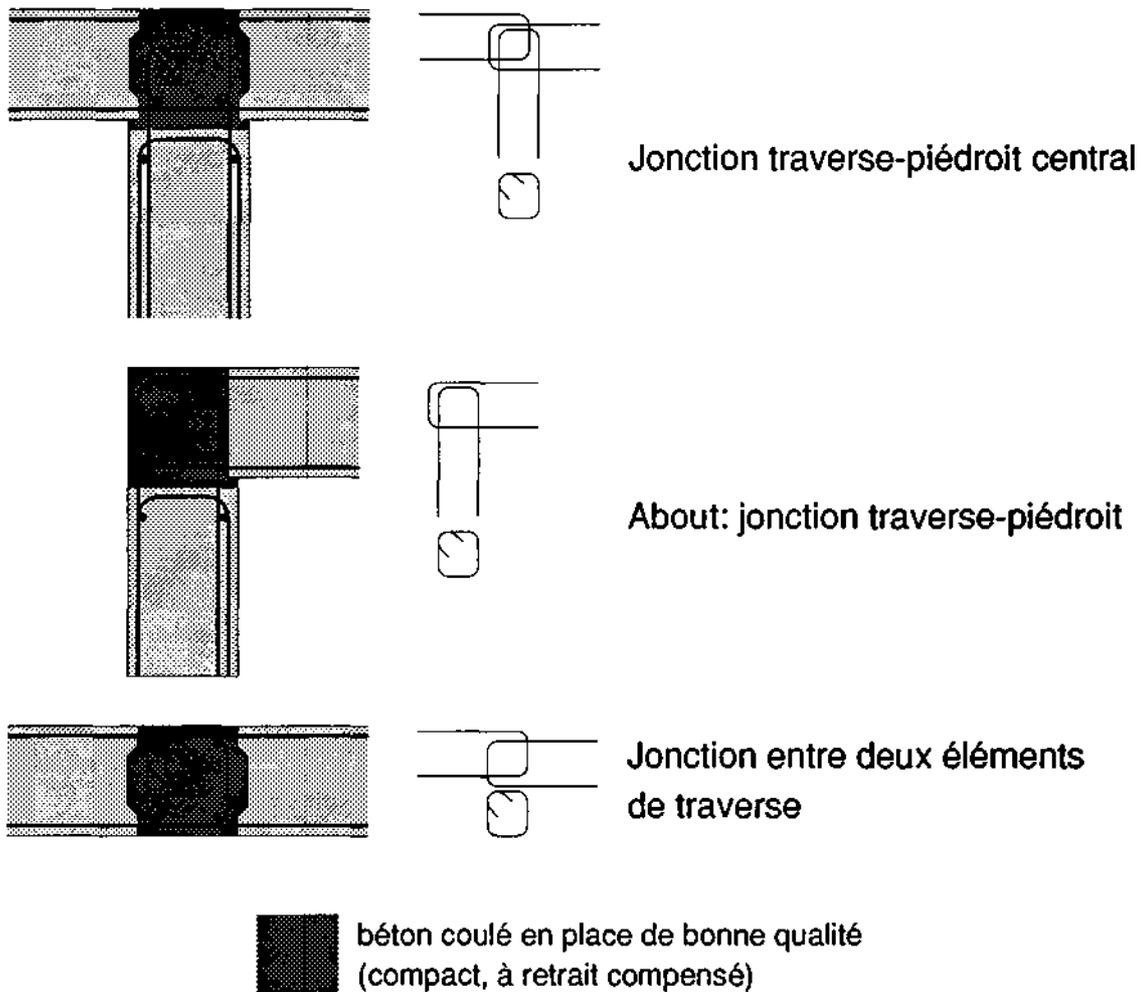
Dispositions de ferrailage dans les éléments de clavage
